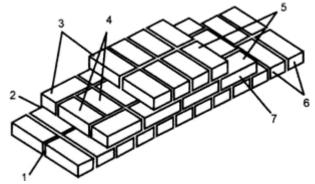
Элементы кирпичной кладки: 1 — вертикальный шов; 2 — горизонтальный шов; 3 — наружная лицевая верста; 4 — забутовка; 5 — внутренняя верста; 6 — тычковый ряд; 7 — ложковый ряд
